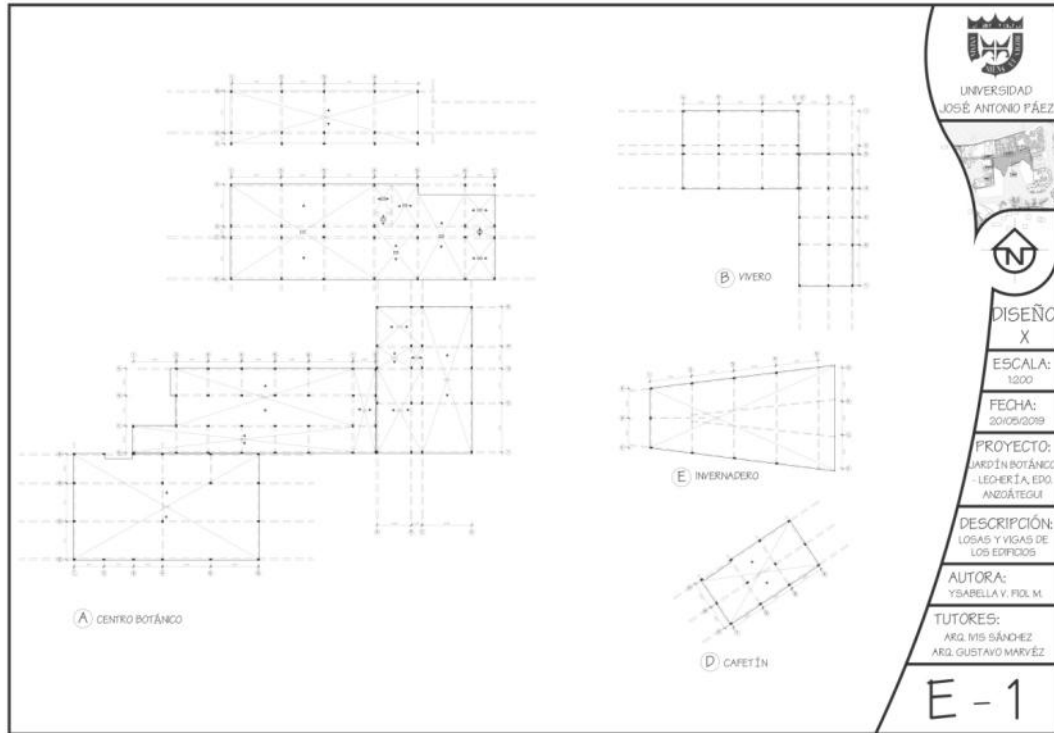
Plano E-1: Losas y Vigas. Fuente: Propia
